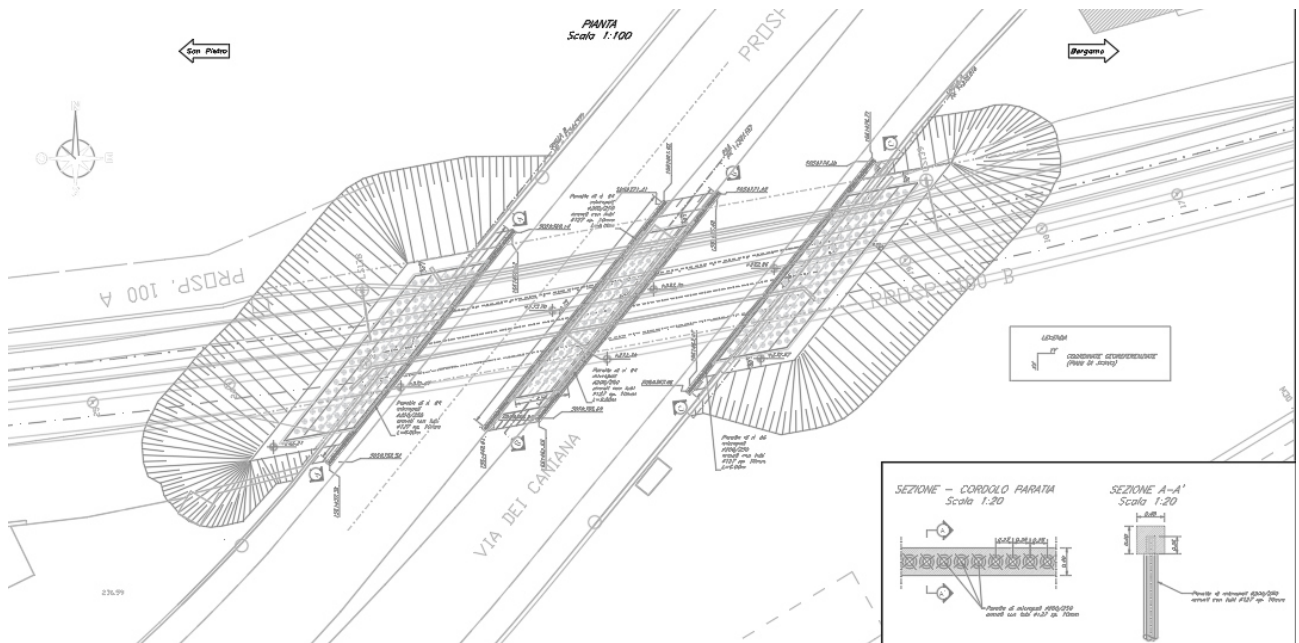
Pianta delle fondazioni e delle opere provvisionali
